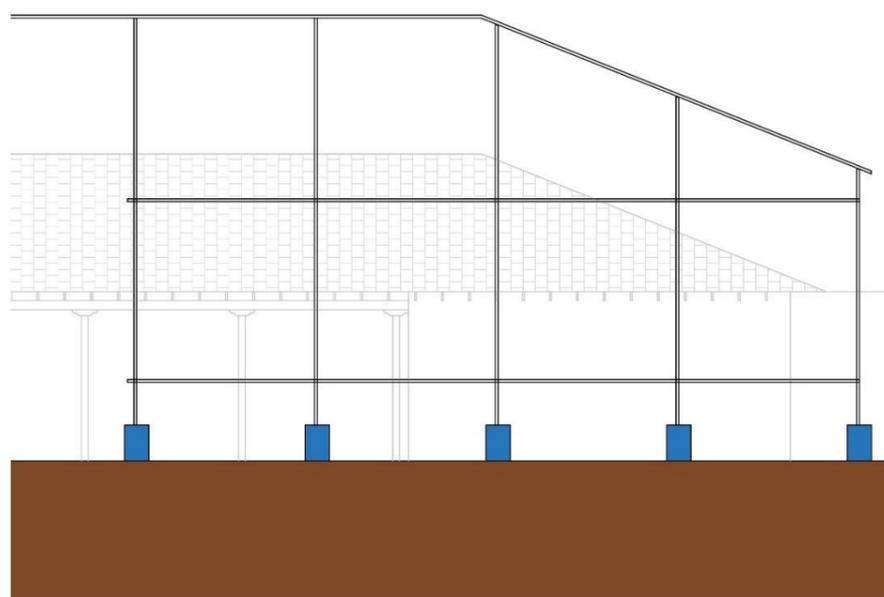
Sobre cubierta. Fuente Luis Segovia 2023
